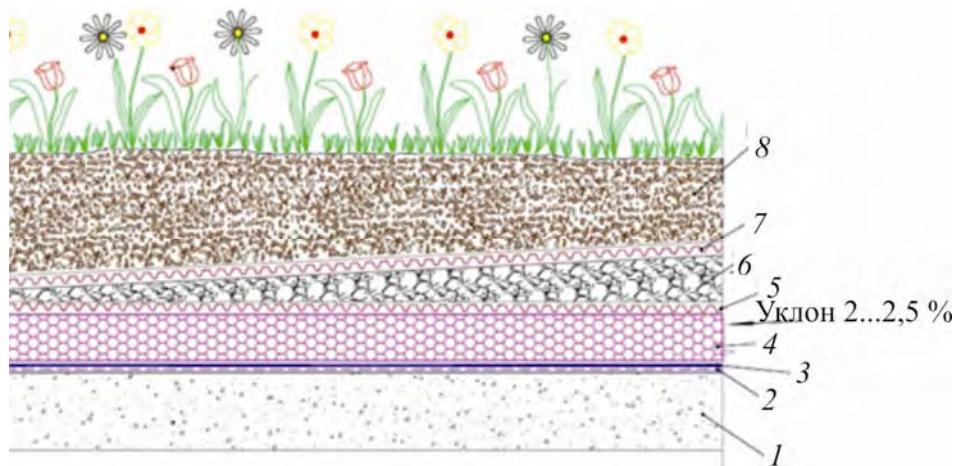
Крыша с грунтовым защитным слоем: 1 — железобетонная плита перекрытия; 2 — грунтослой; 3 — гидроизоляционный ковер из рулонных материалов; 4 — экструдированный пенополистирол; 5 — фильтрующий материал; 6 — дренарующий слой гравия; 7 — фильтрующий материал; 8 — почва
